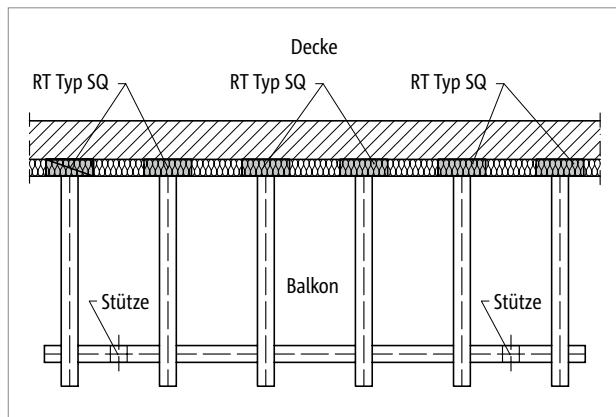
Schöck Isokorb® RT Typ SQ: Erneuerung eines Bestandsbalkons, gestützte Konstruktion
